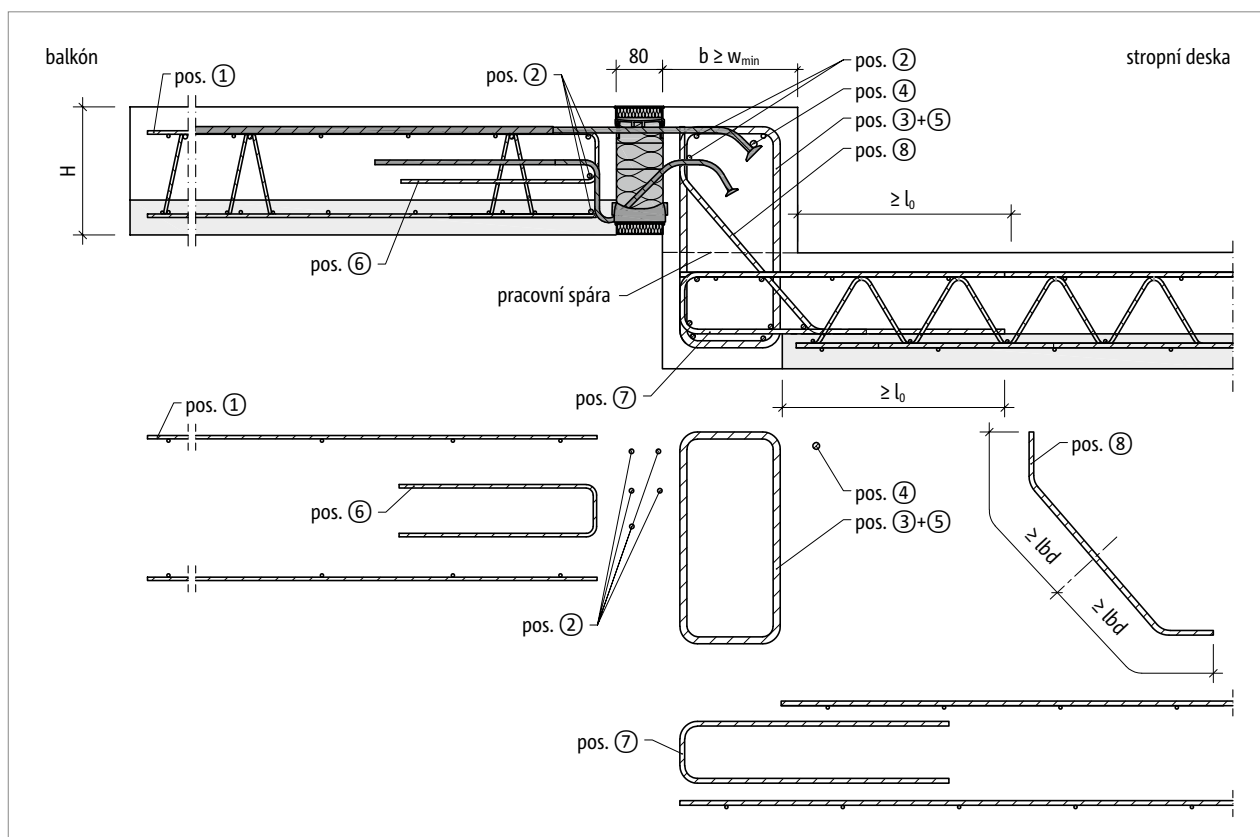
Schöck Isokorb® T typ KL-O-F: Napojovací stavební výztuž pro balkón nadvýšený oproti stropní desce
